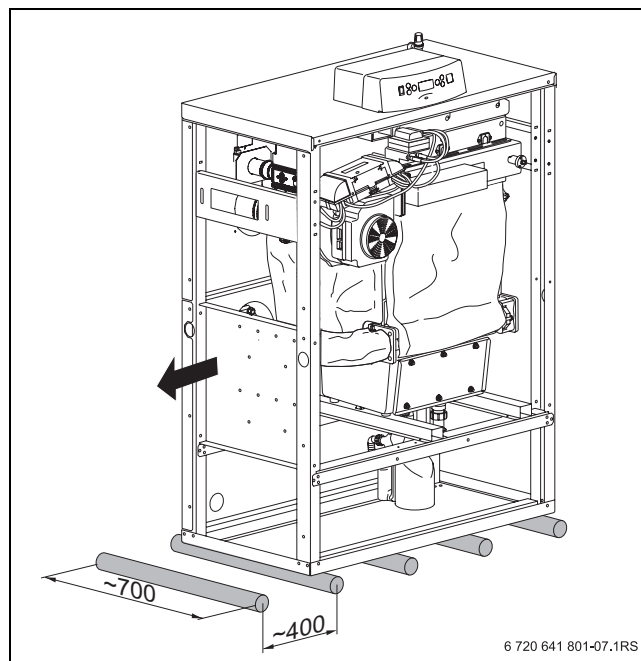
Transport de la chaudière sur rouleaux (dimensions en mm)
